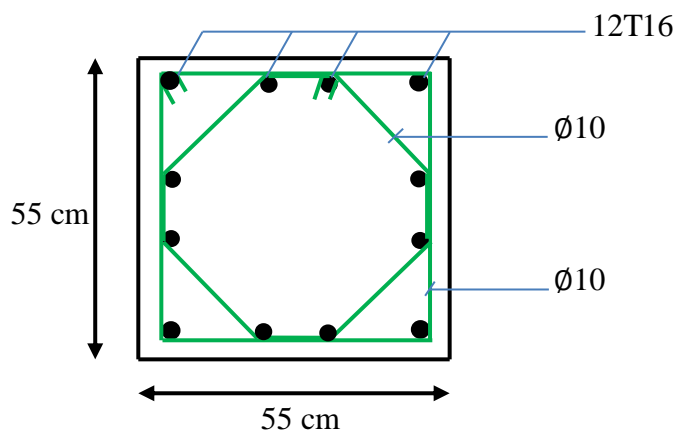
Ferrailage des poteaux (Etage 1 et 2).
